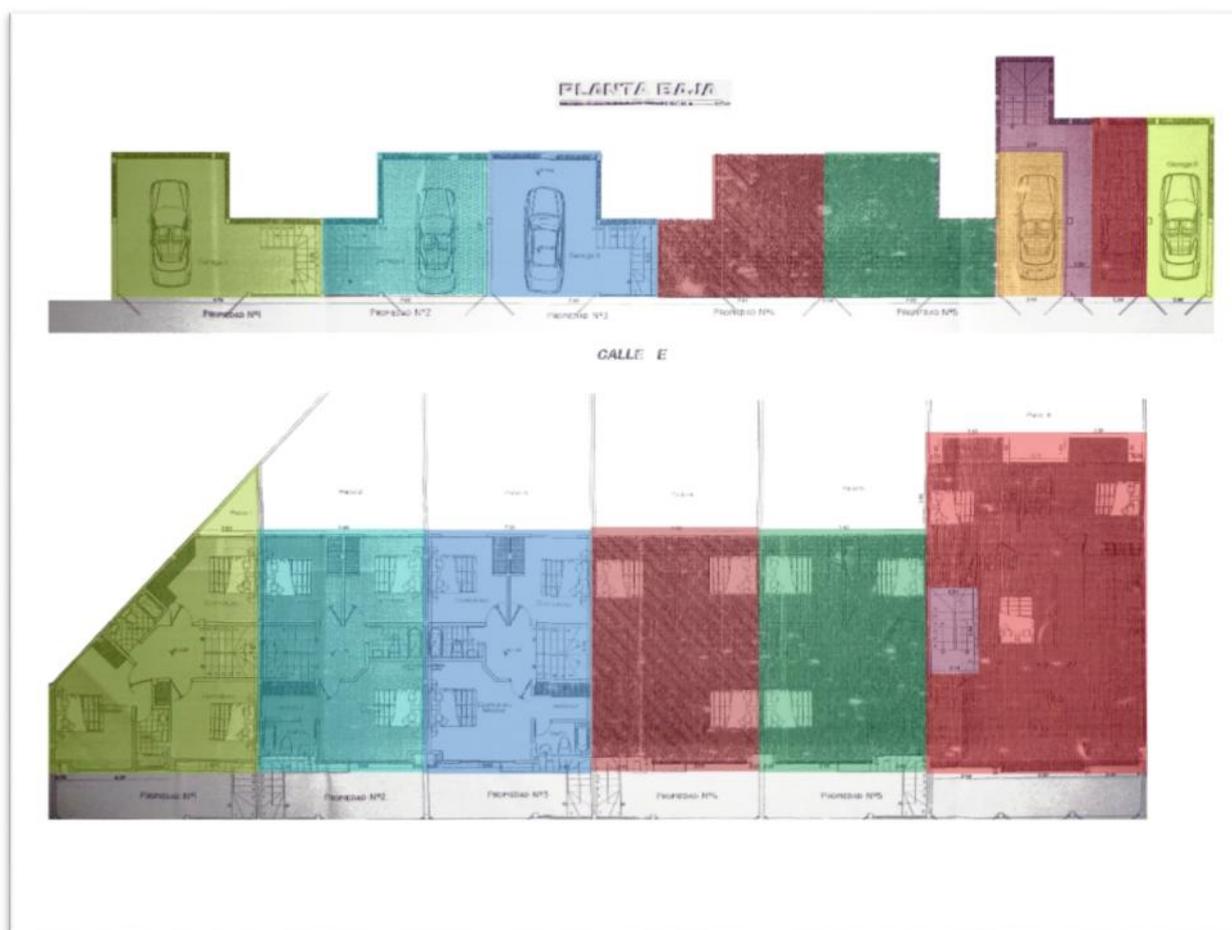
Planimetría del conjunto. Las propiedades se encuentran diferenciadas por color.
